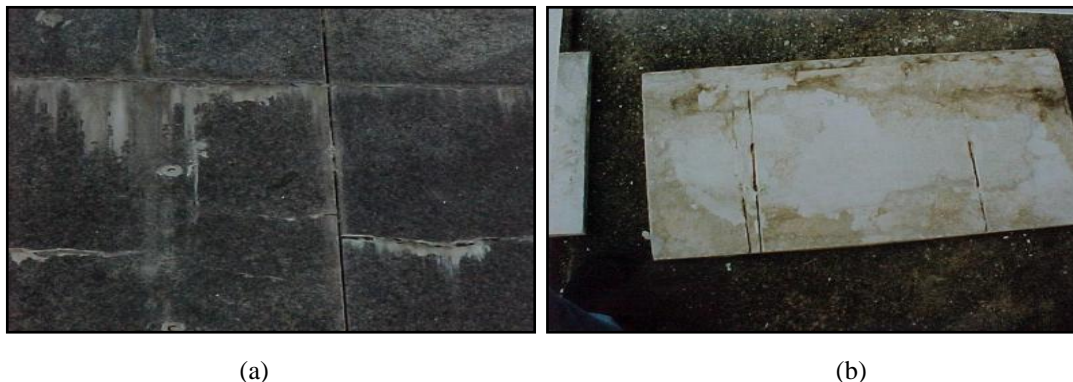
(a) Fissuras e eflorescências e (b) Descolamento de placas por má distribuição da argamassa
